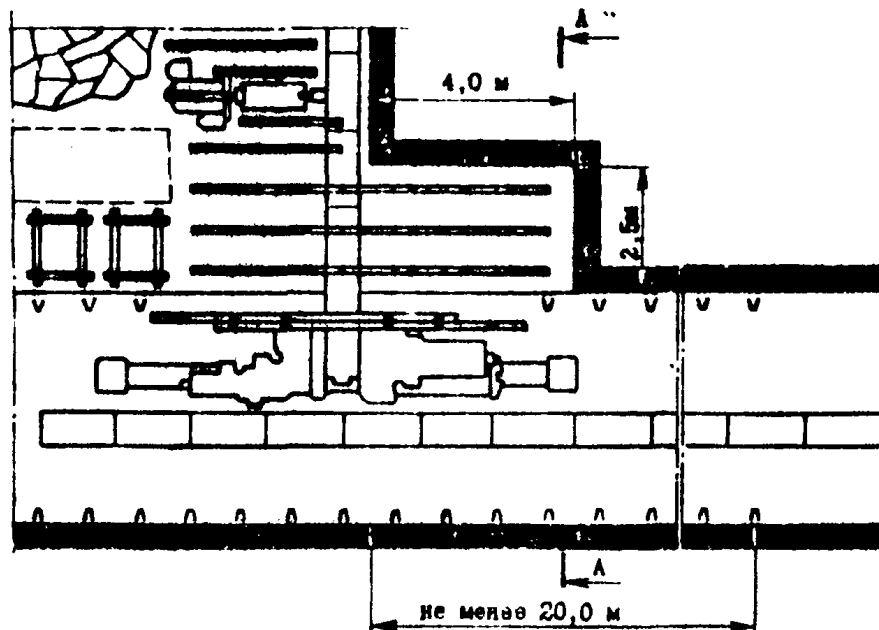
Схема сопряжения при неустойчивой непосредственной кровле
